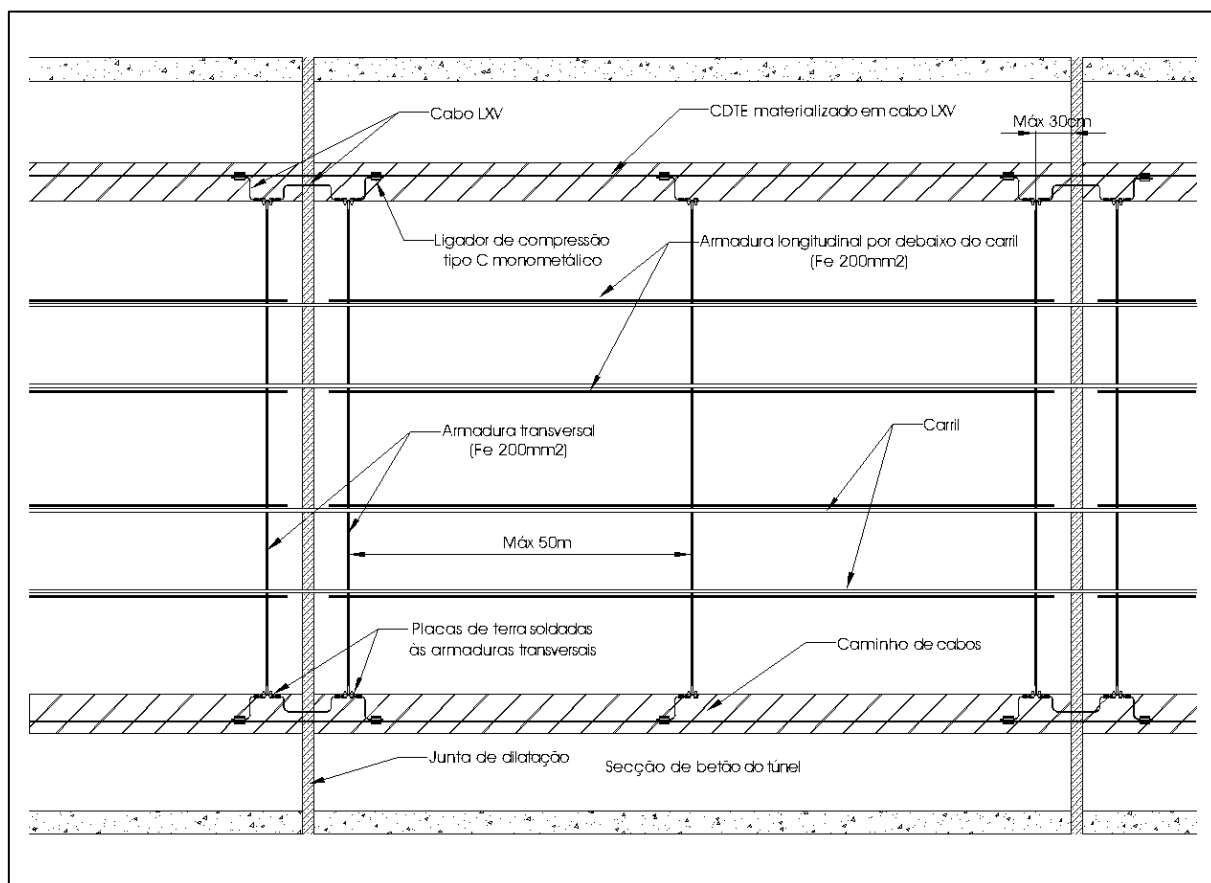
Ligação à terra das armaduras de betão armado em revestimento de túneis betonado in-situ
